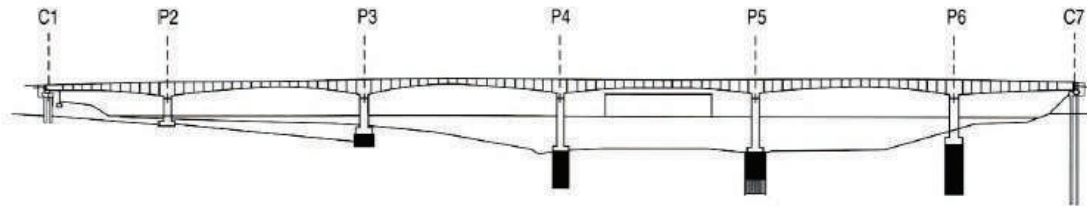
Pont en béton précontraint construits par l'encorbellement successif.
